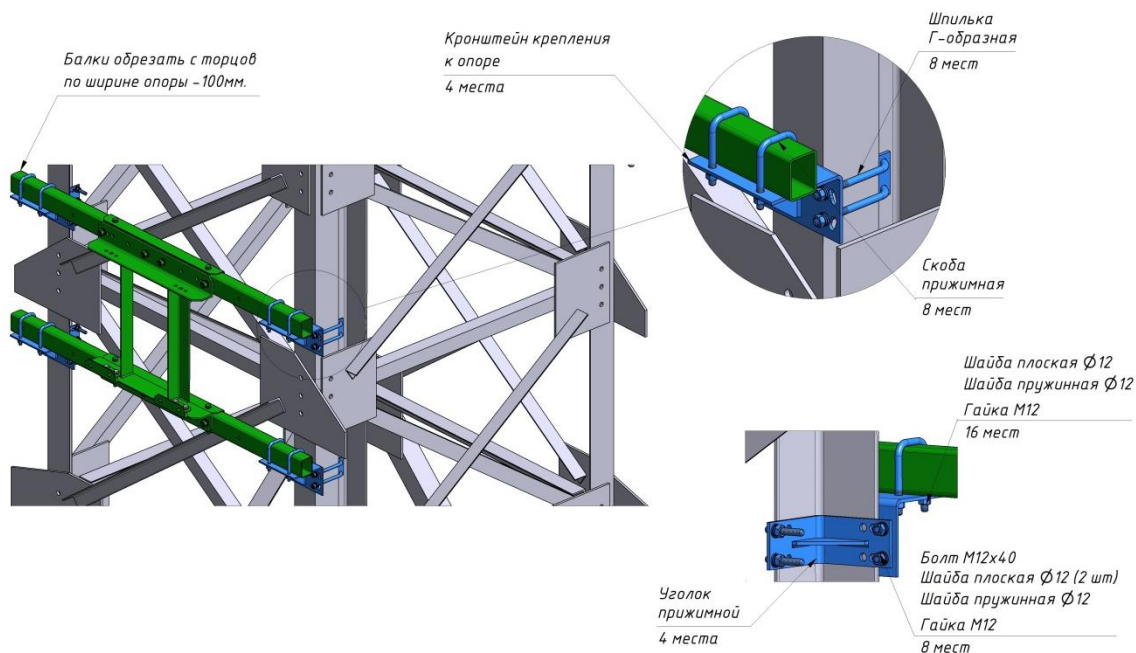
Крепление присоединительной рамы к стальной опоре
